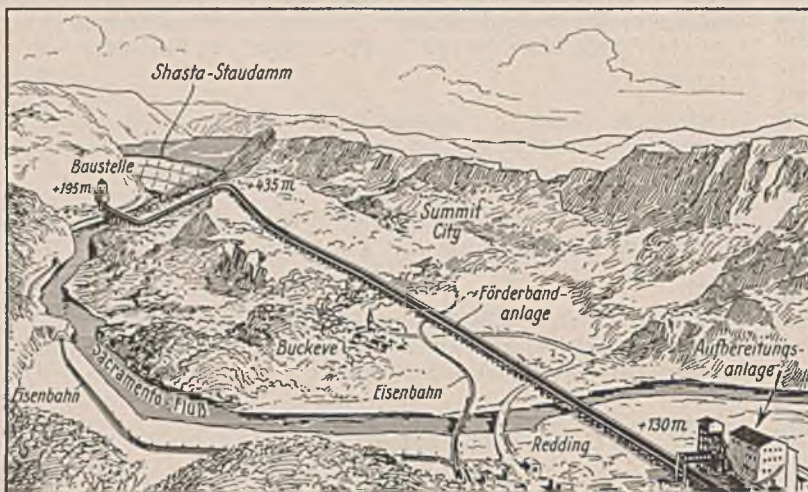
Lageplan der Förderbandanlage aus 26 Einzelbändern. Gesamtlänge 15 km.
